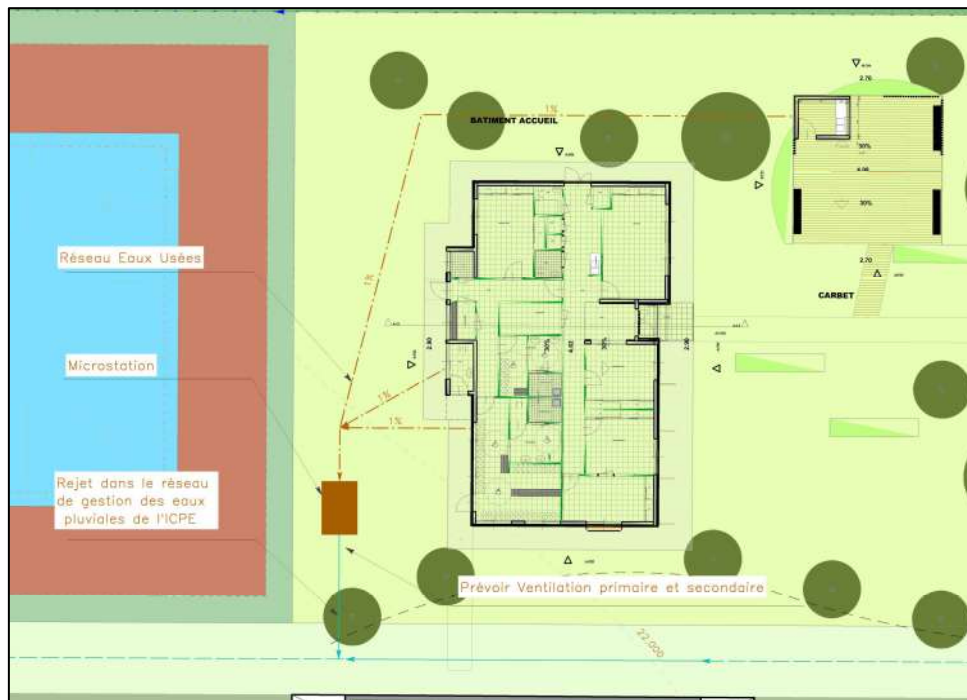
Plans de localisation du dispositif d'assainissement non collectif
